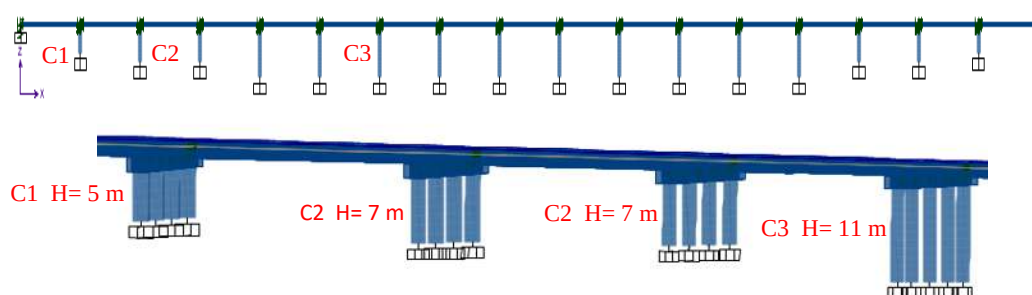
Variación de la altura de las columnas en las pilas del puente Miguel Alemán.
